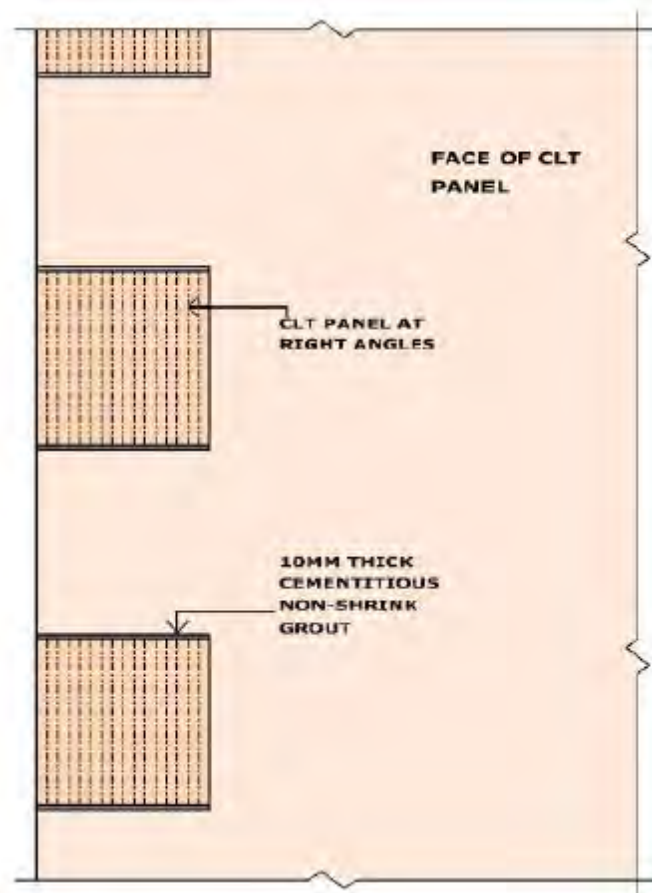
Particolare costruttivo del giunto d'angolo tra pannello-pannello. Immagine tratta da "Integrating cross-laminated timber panels to construct buildings to twenty levels" John Chapman.
